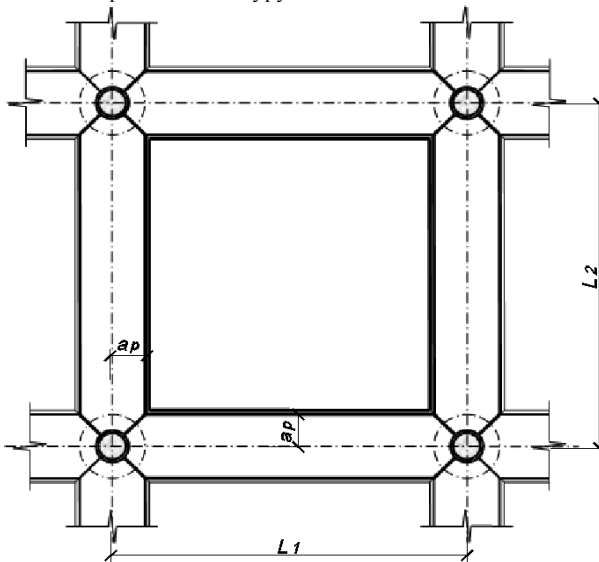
Фрагмент збірного сталезалізобетонного безбалкового перекриття з плитою-вставкою
